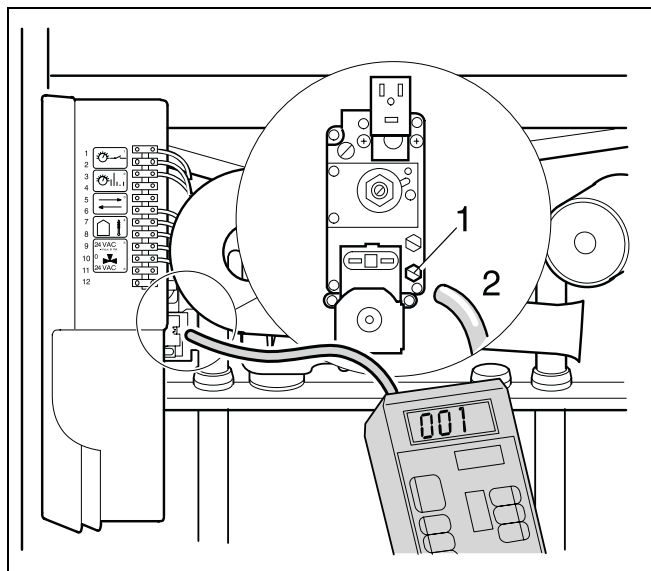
Misurare la pressione di collegamento del gas (apparecchiatura SIT)
